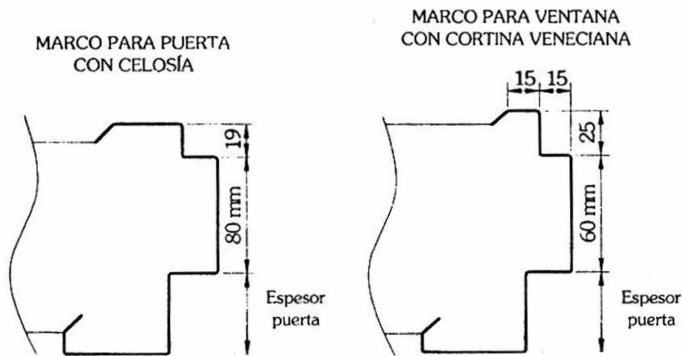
a. Perfiles de carpintería metálica, en chapa doblada (medidos en mm).
